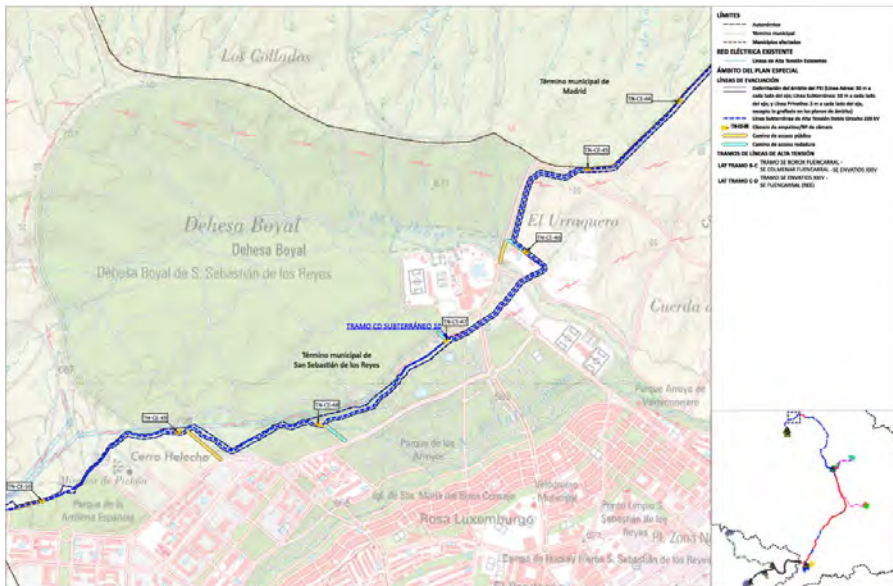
Plano de Ordenación O2.5.12. Planta por tramos. LASAT Promotores Nudo Fuencarral Tramo C-D
